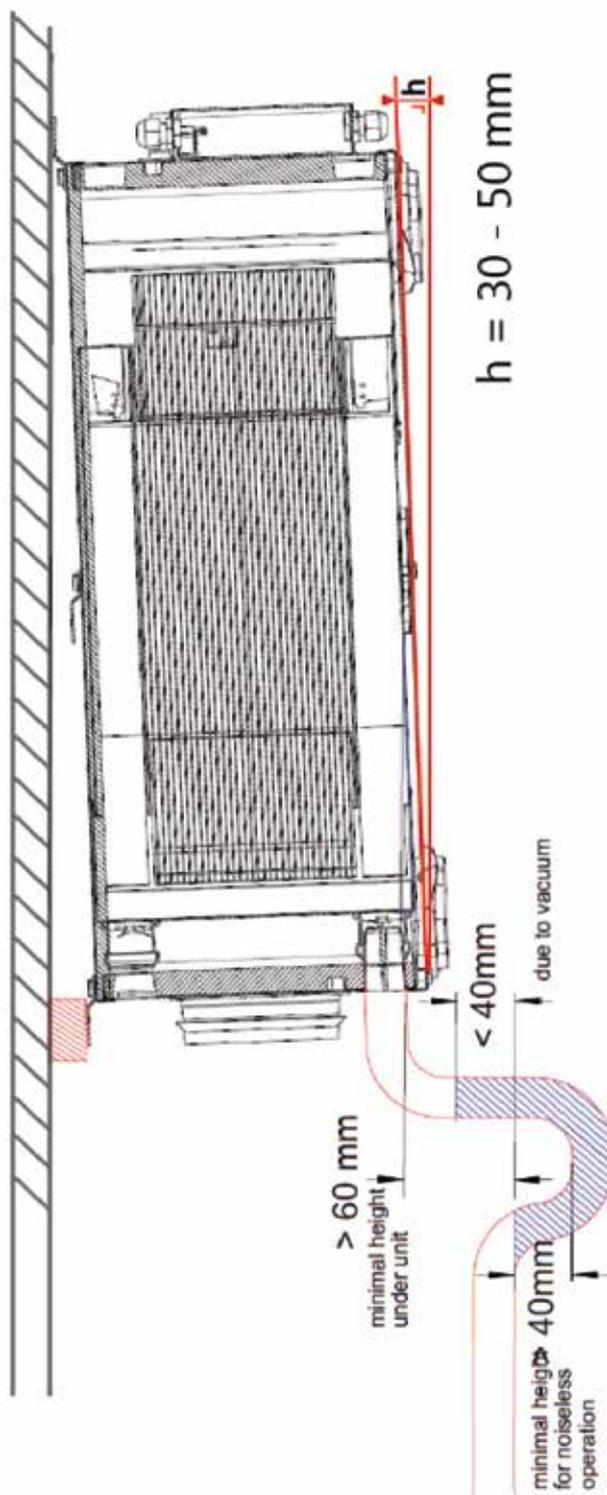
B: MONTAGE PLAFOND AVEC COUPE-AIR À BOULE
